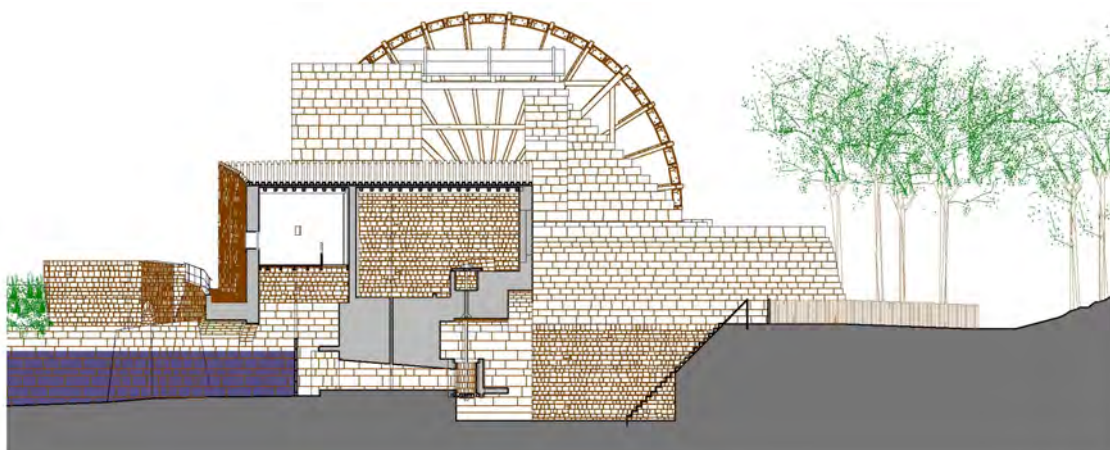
Plano del norial, seccionado por el molino harinero. Autor: Javier Ibargüen Soler.
